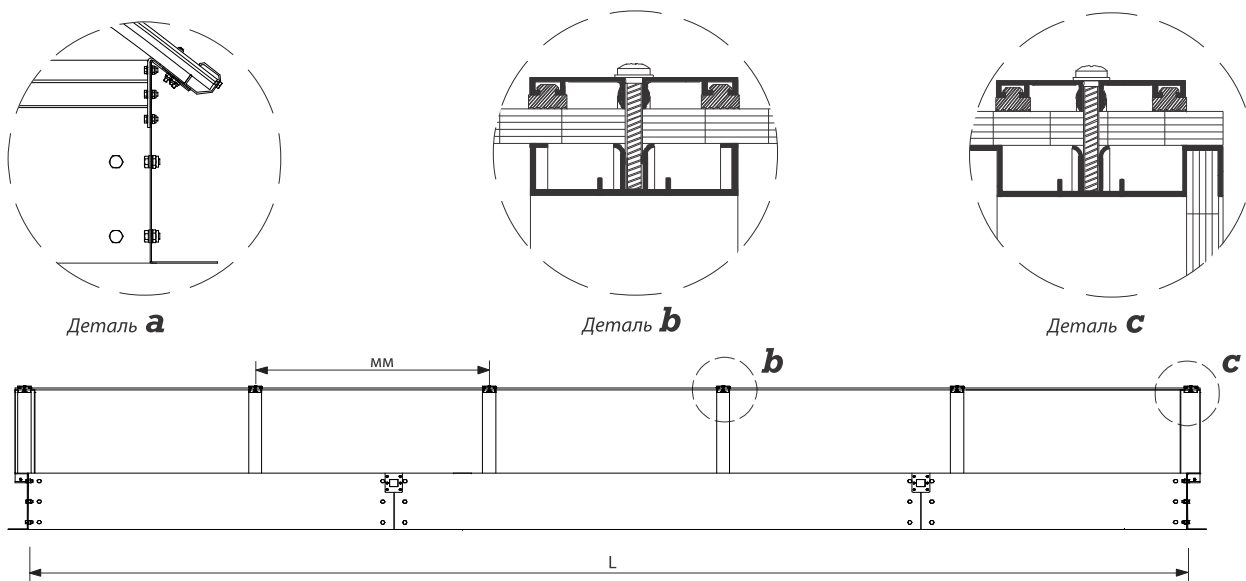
Продольное сечение B-B световой полосы с арочным сводом
